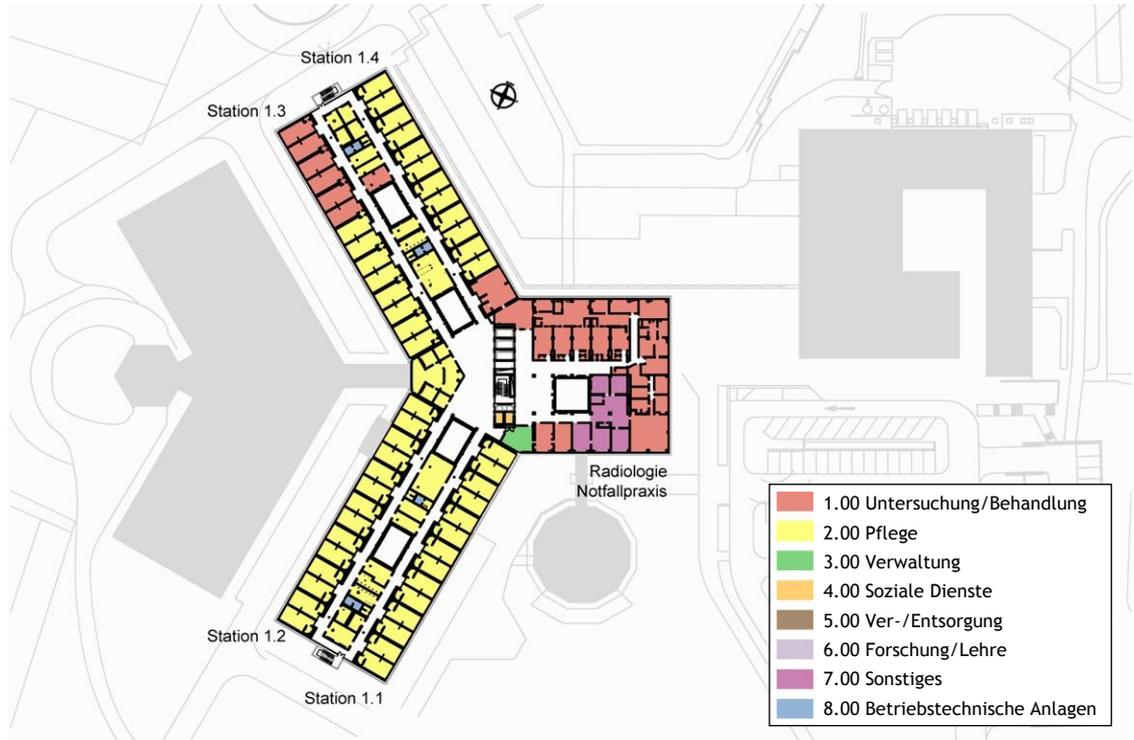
Bestandsflächen nach DIN 13080 - 1.Obergeschoss
